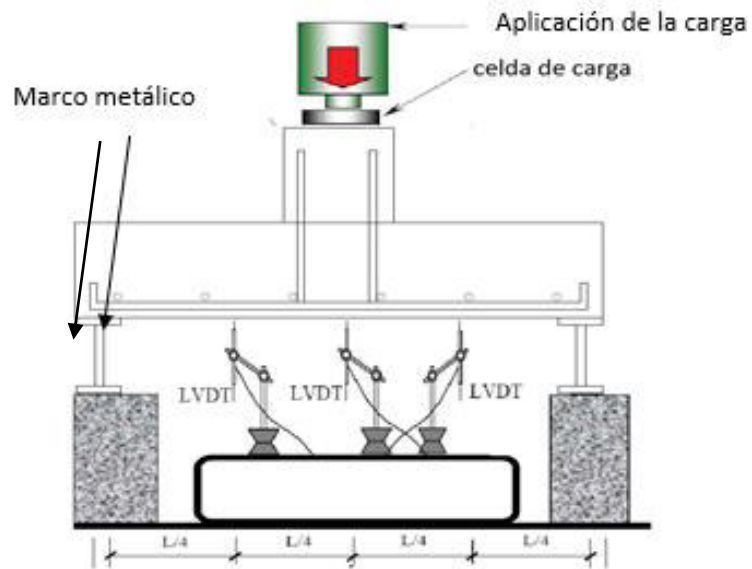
Esquema del montaje para fallas por punzonamiento en un sistema losa-columna (NGUYEN, et al, 2011)
